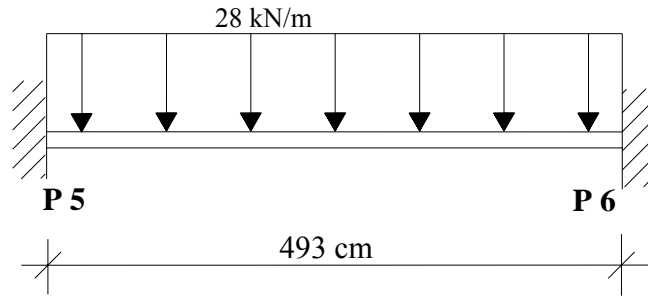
Esquema estático e carregamento no vão da viga adjacente ao pilar.
